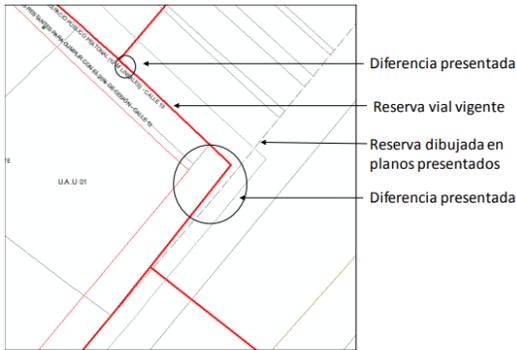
Diferencias de reserva vial vigente. Fuente: Montaje de planos presentados y reserva vial vigente Av. Colón y Av. NQS.
